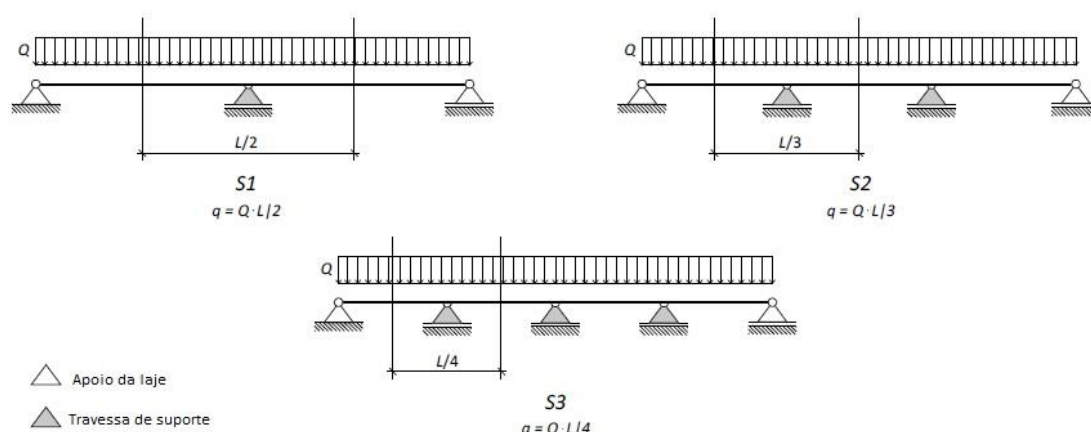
Esquema das cargas de projeto ("S"). Q é a carga da laje.
